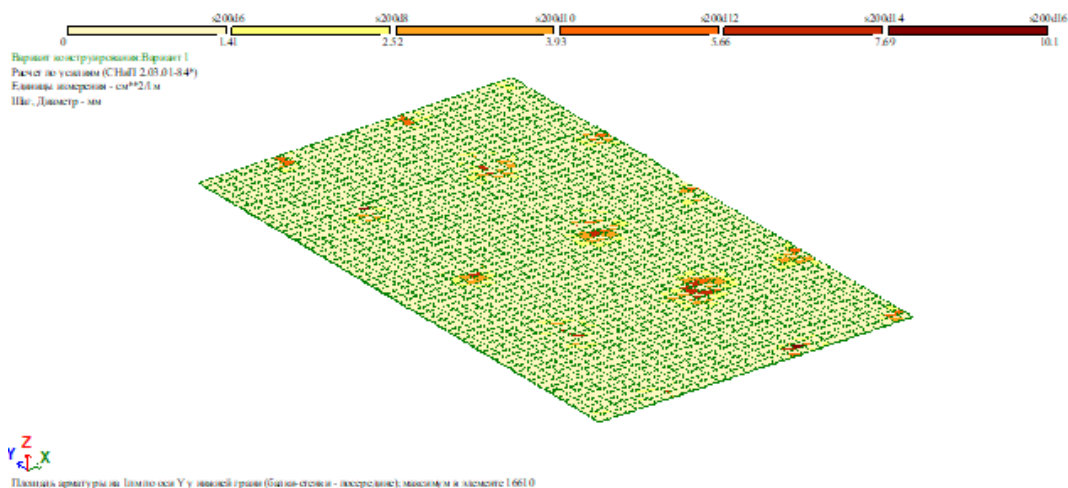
Схема армування плити по осі Y у нижній грані
